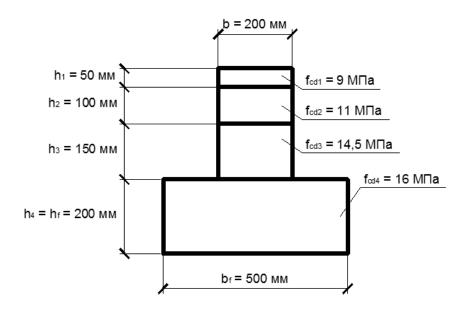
Сечение фундамента (к решению задачи 1)
